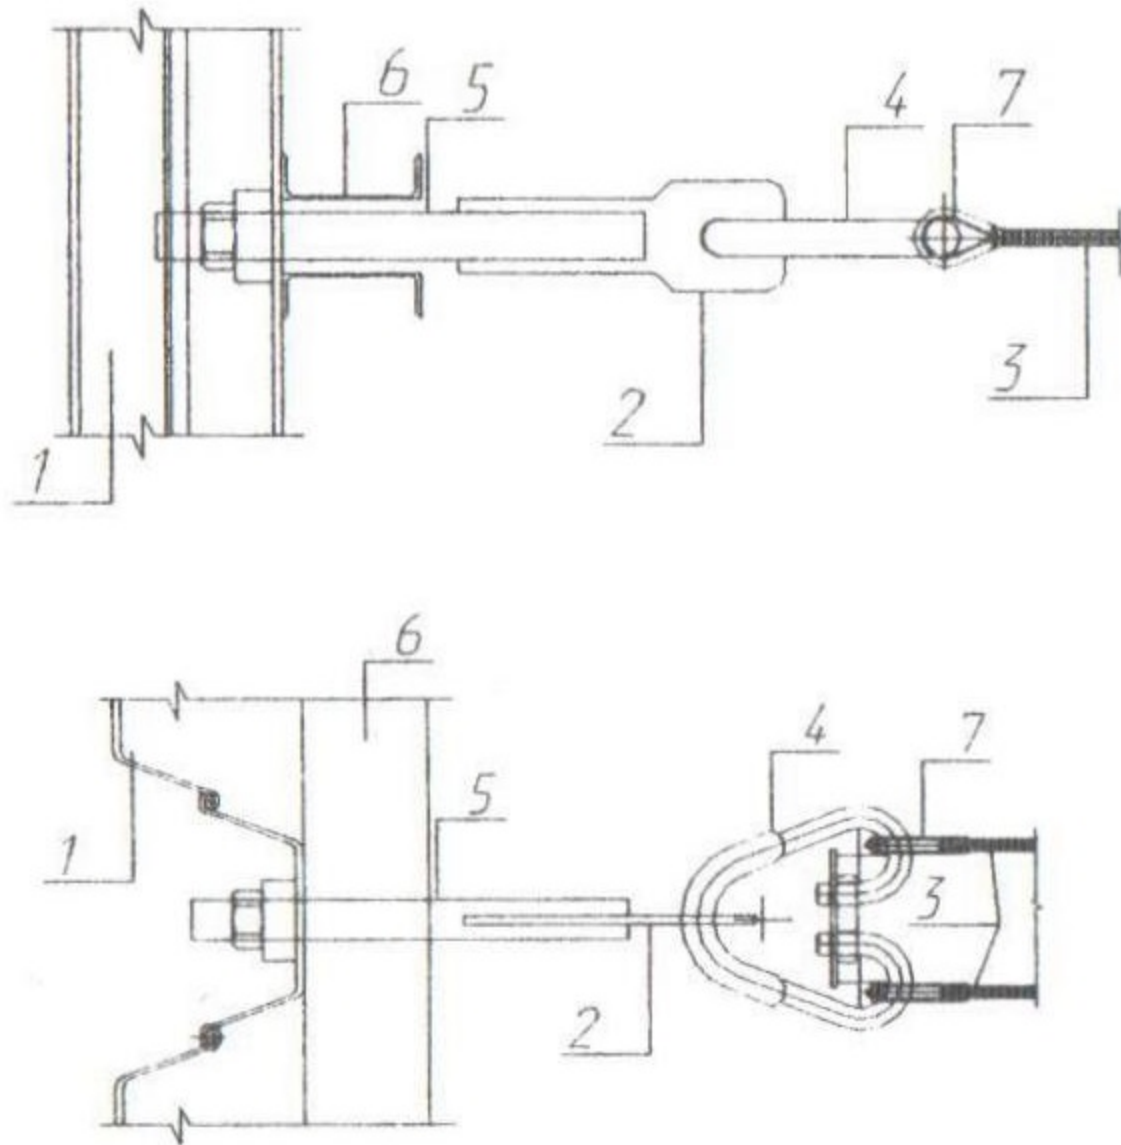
Крепление анкерной тяги к конструкциям причала:
